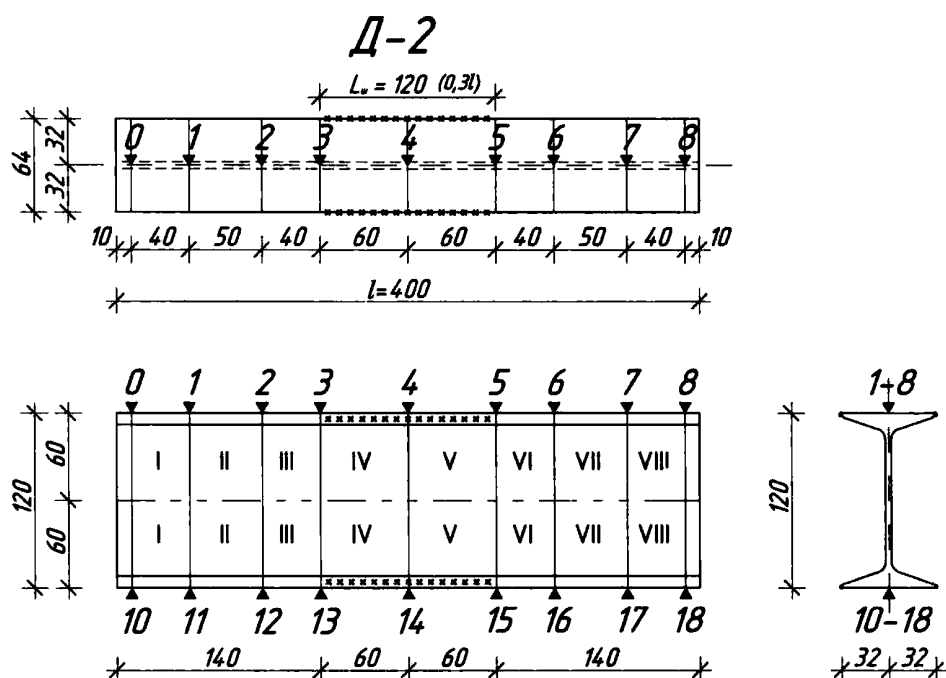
Схема наплавления сварных валиков в образце Д-2
